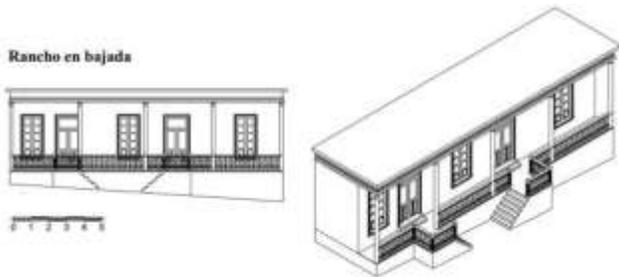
Tipos de rancho. Barranco. Elaboración M. Sarmiento
